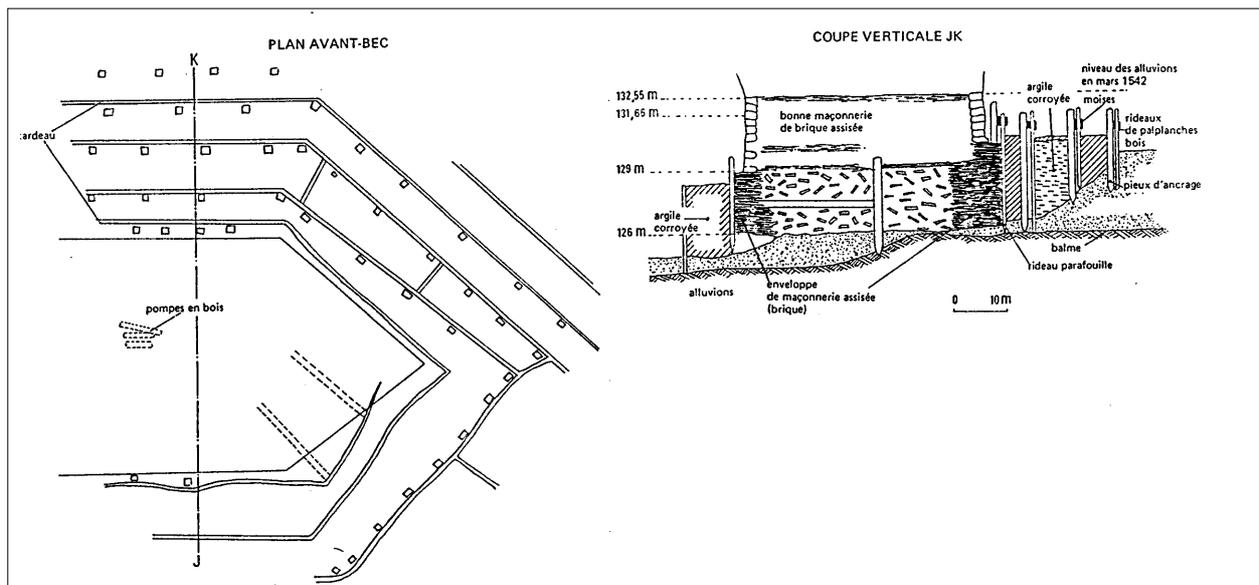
PLAN DE L'AVANT-BEC ET COUPE DE LA 7^e PILE (n° 1 actuelle) d'après R. Lotte, pl. 8. montrant le relevé des vestiges des enceintes du batardeau dressé pour la construction de la pile par Pierre Souffron et Dominique Capmartin en 1597-1601.
